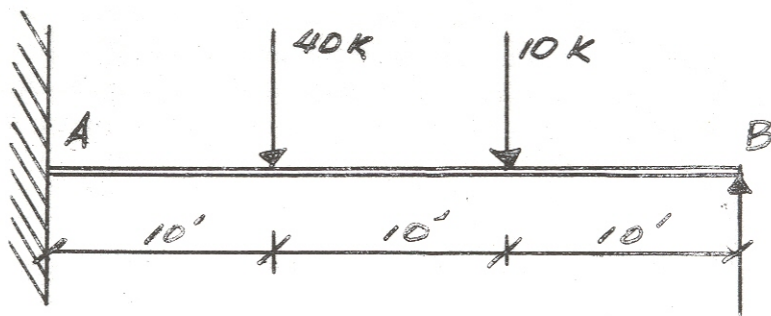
Viga Indeterminada Diseñada Plásticamente.
